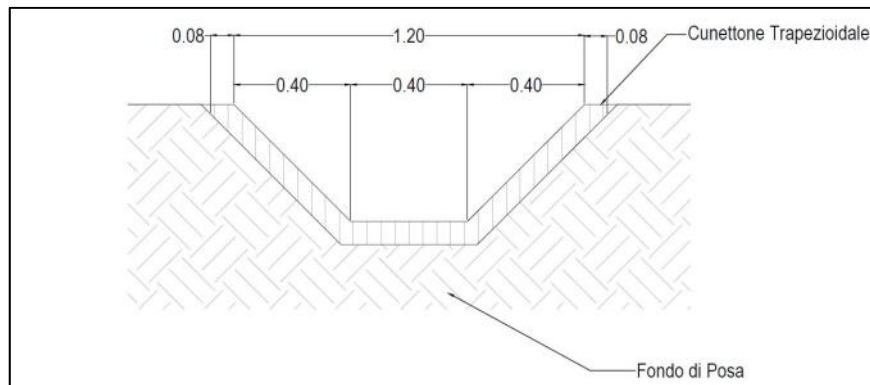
CUNETTORE trapezoidale prefabbricato 40 x 40 x 40
